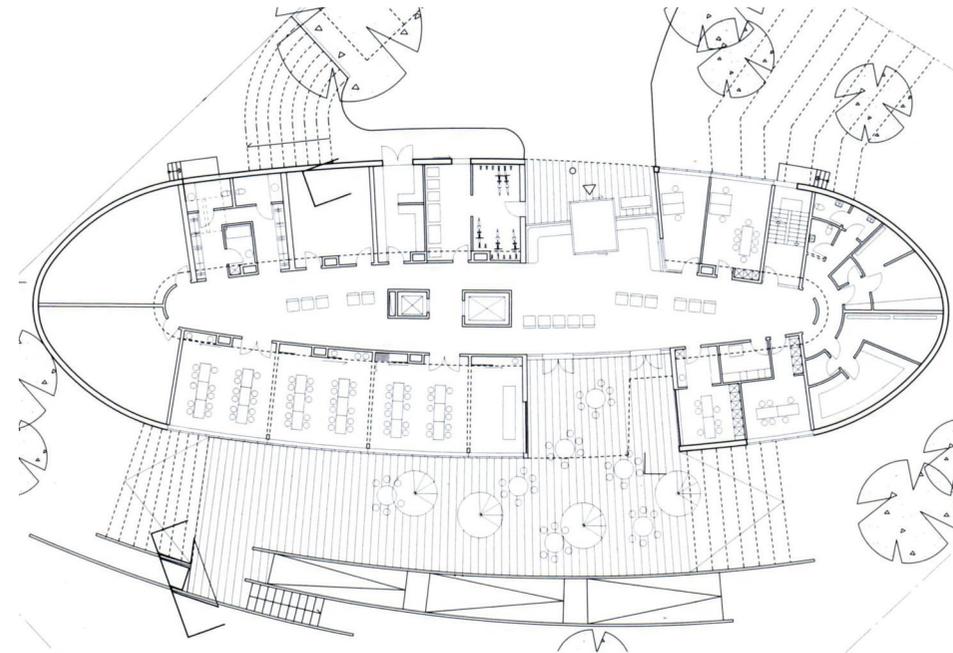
Grundriss Erdgeschoss M 1:500
